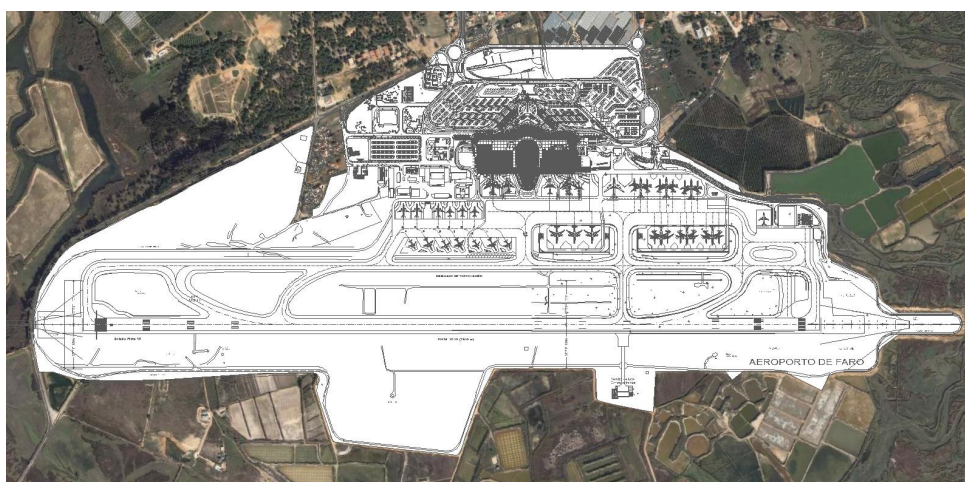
Layout do Aeroporto de Faro após Plano de Expansão
